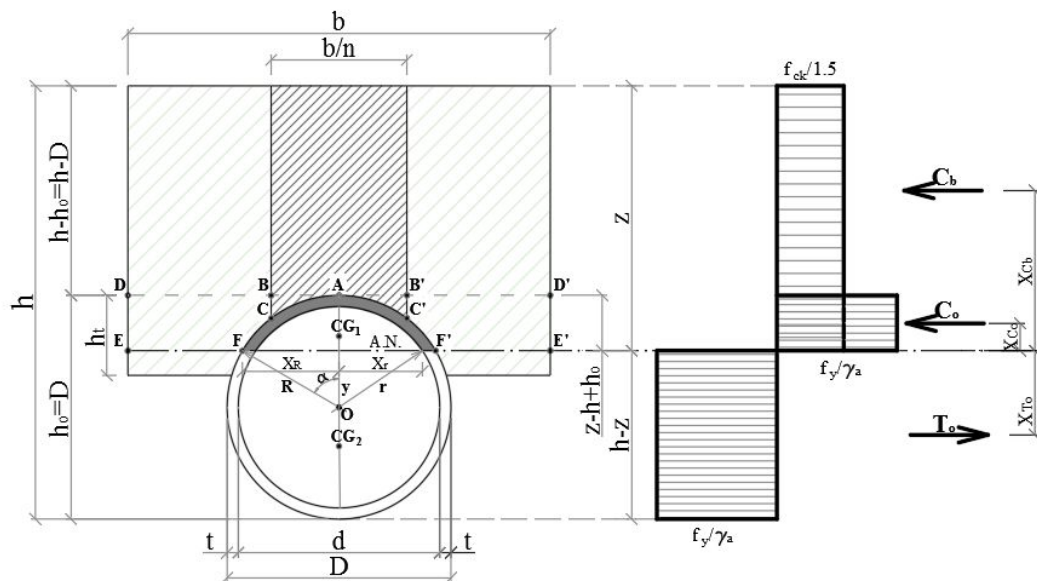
4. Model de calcul al structurii mixte oțel-beton cu structura metalică din țevi distanțate
